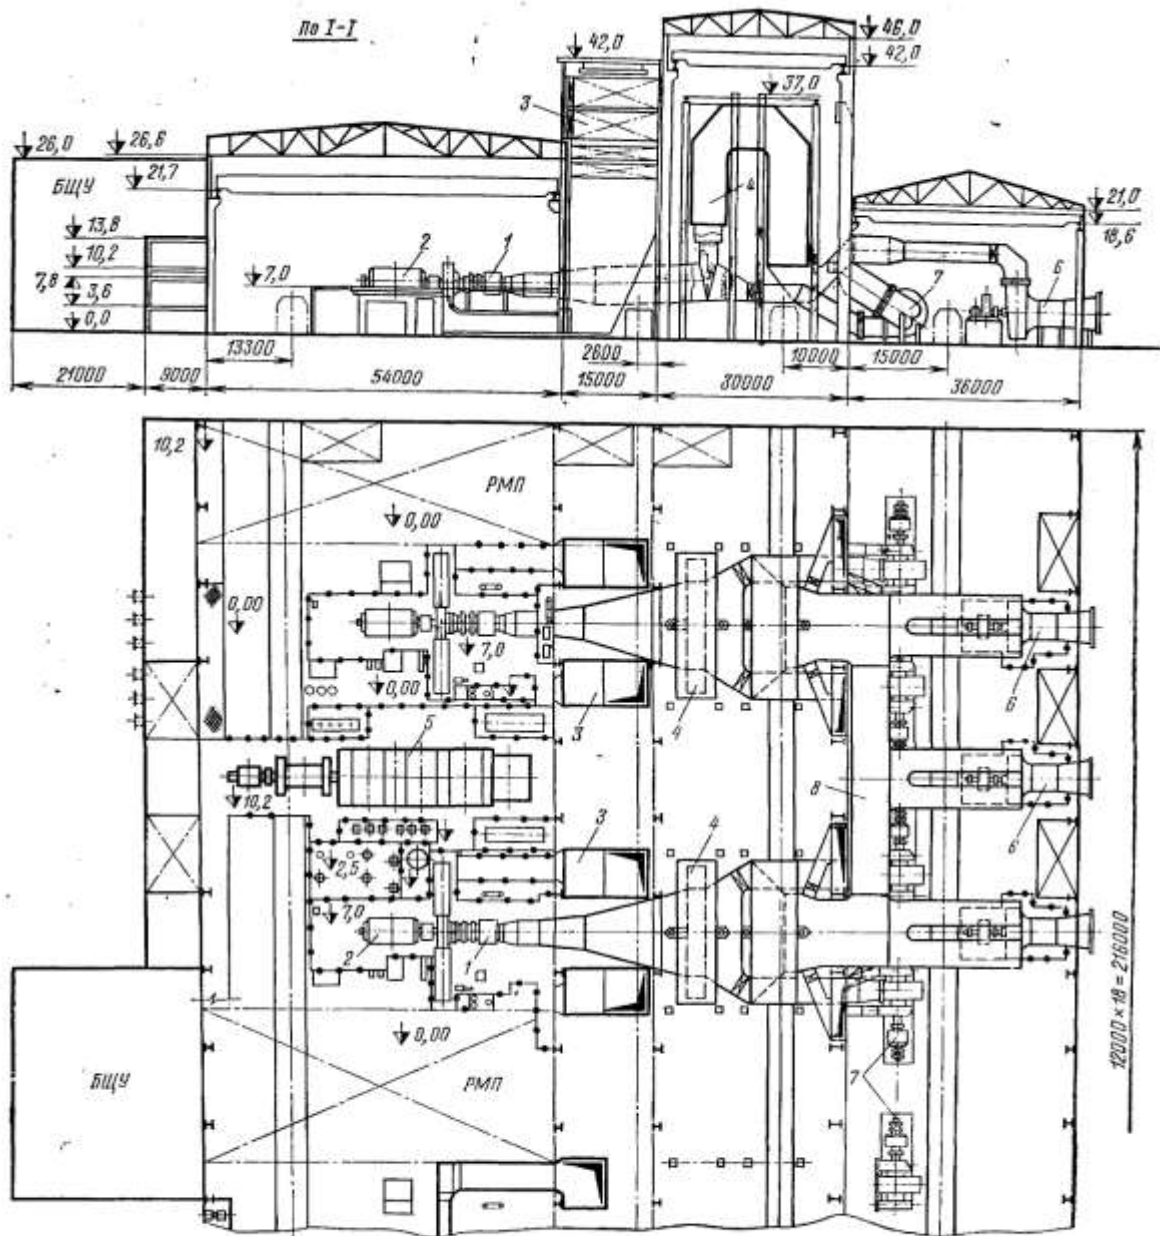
Вариант компоновки главного корпуса парогазовой установки ПГУ-800:
